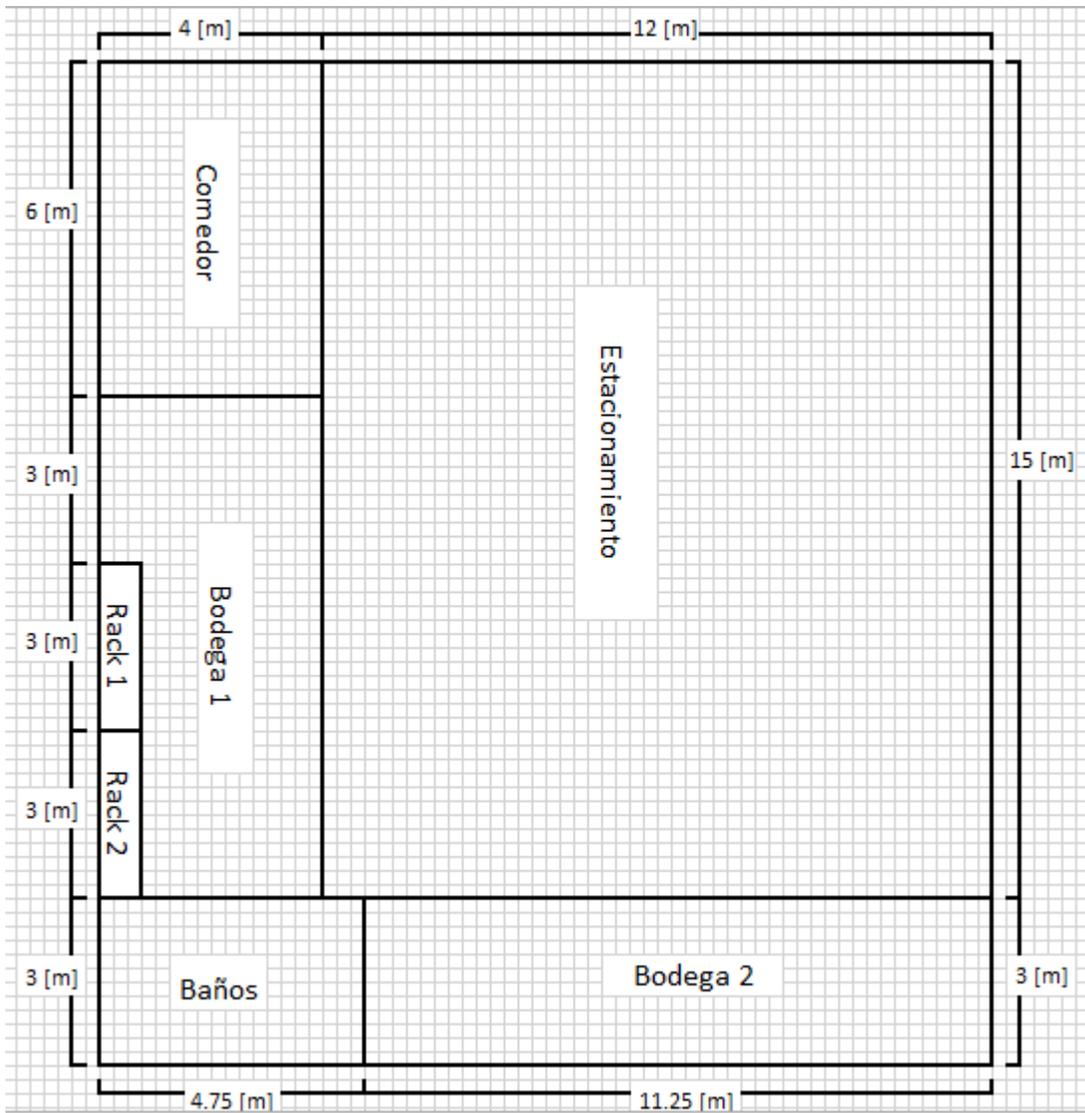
Plano bodega Valparaíso. Fuente: elaboración propia
